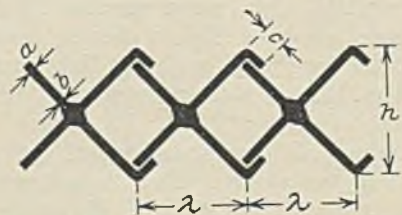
Eisernen Spundbohle mit kreuzförmigem Querschnitt, Bauart Krupp.
